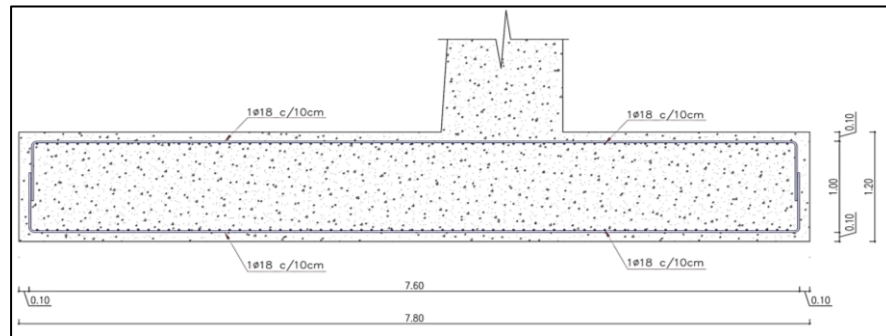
Diseño definitivo de la zapata del estribo. Fuente: Autor
